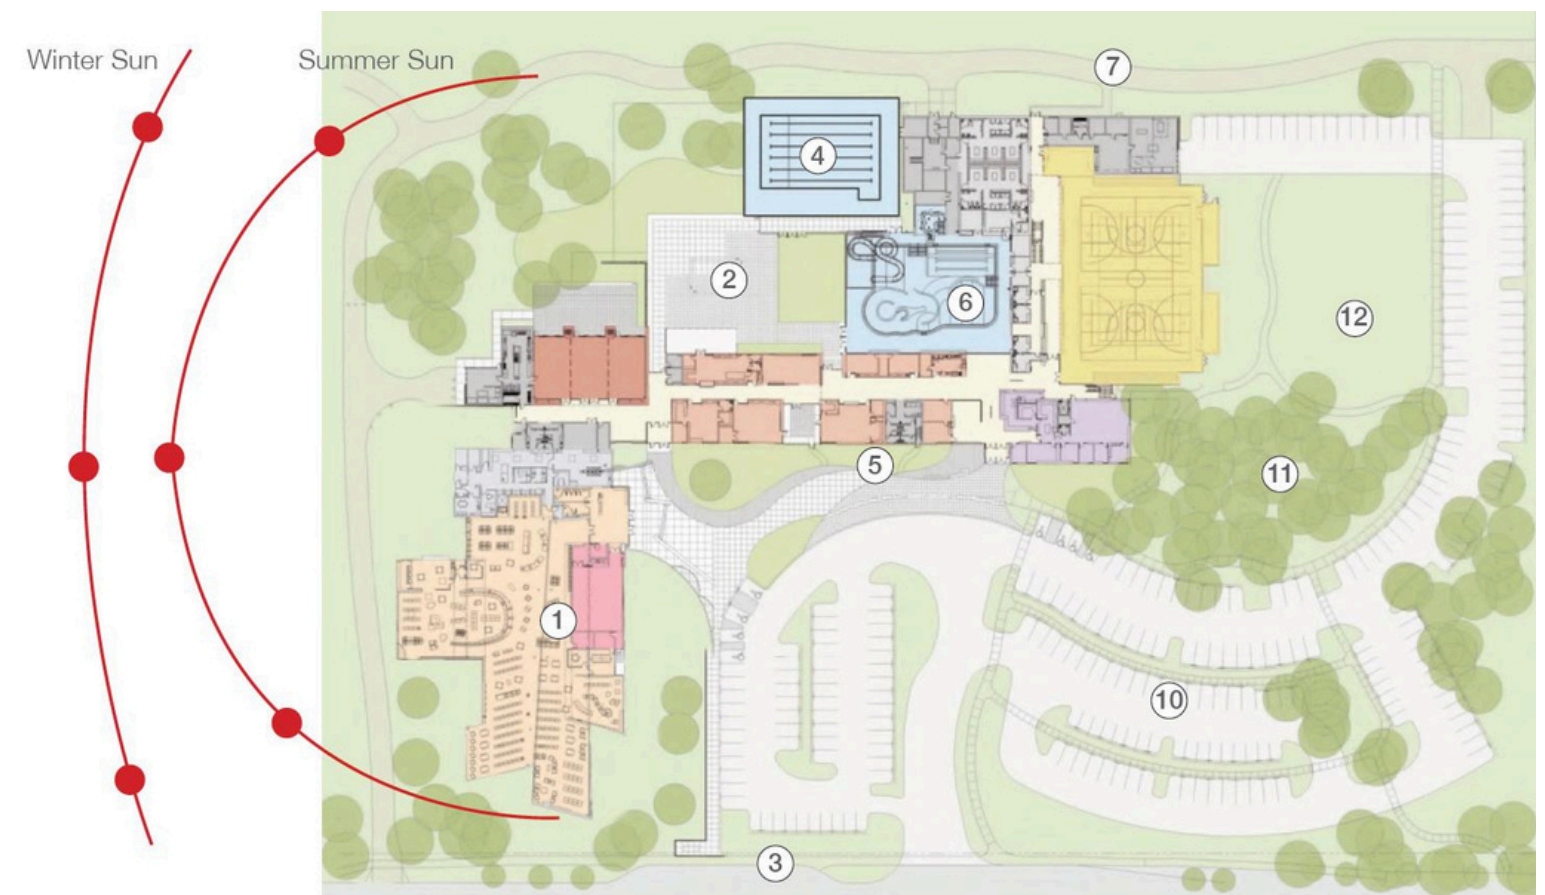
24 Planta de Conjunto. Fuente Opsis
